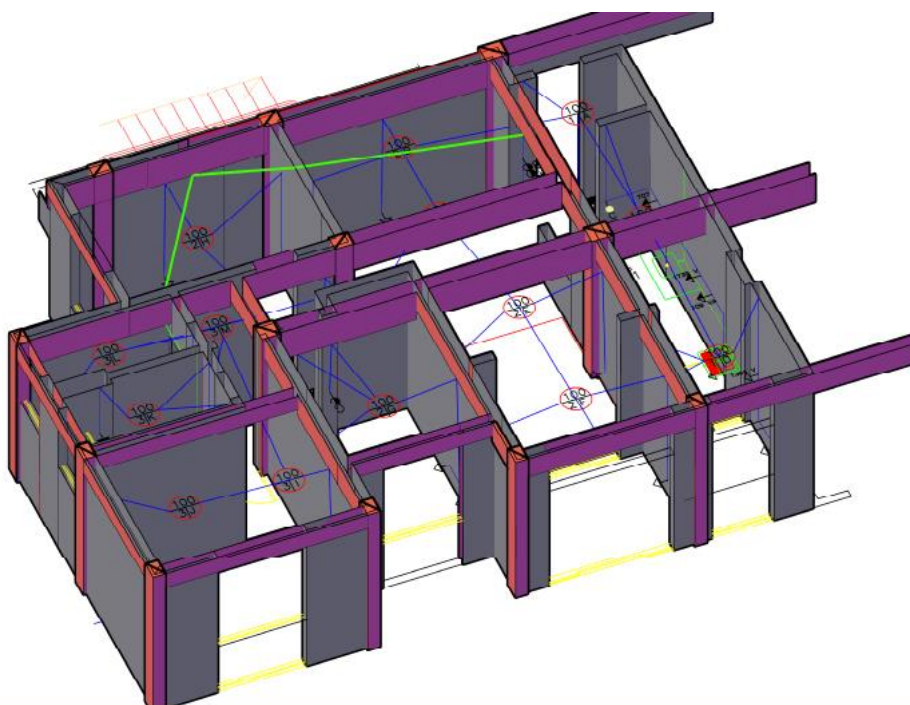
Modelagem 3D feita no Civil 3D das instalações juntamente com o projeto estrutural.
